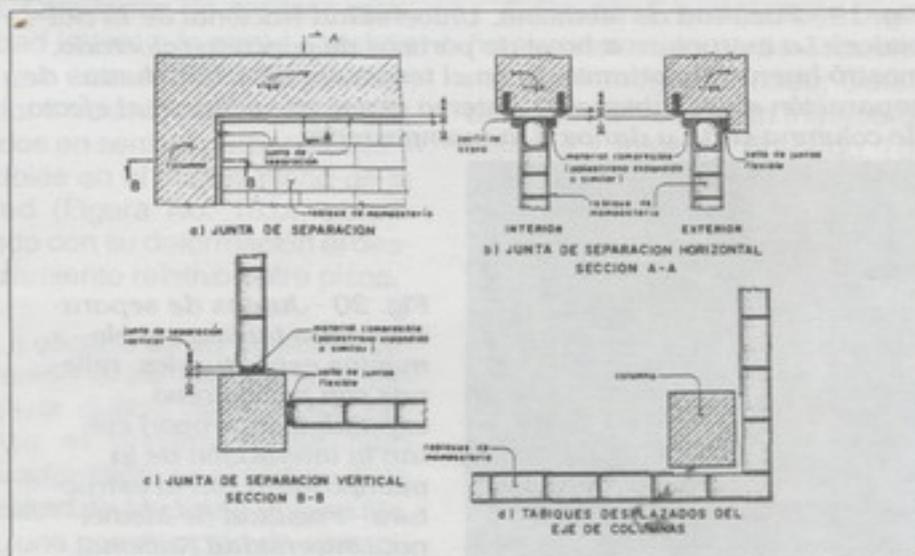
Detalles constructivos tendientes a separar los elementos de mampostería de la estructura - a., b. y c.) Juntas de separación verticales y horizontales - d.) Tabiques desplazados del eje de las columnas.
